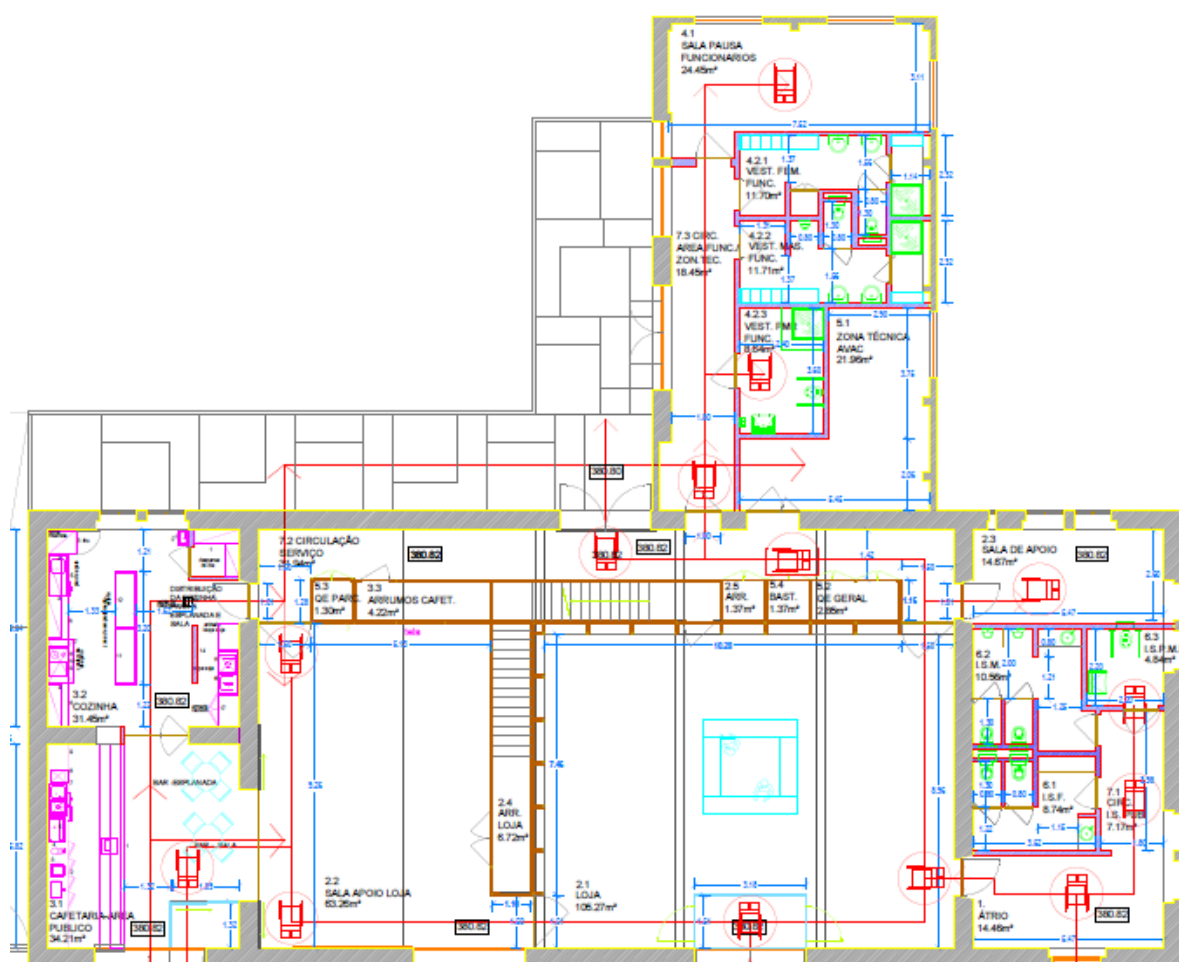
Planta do piso 0 do edifício (AutoCAD™ 2017)
